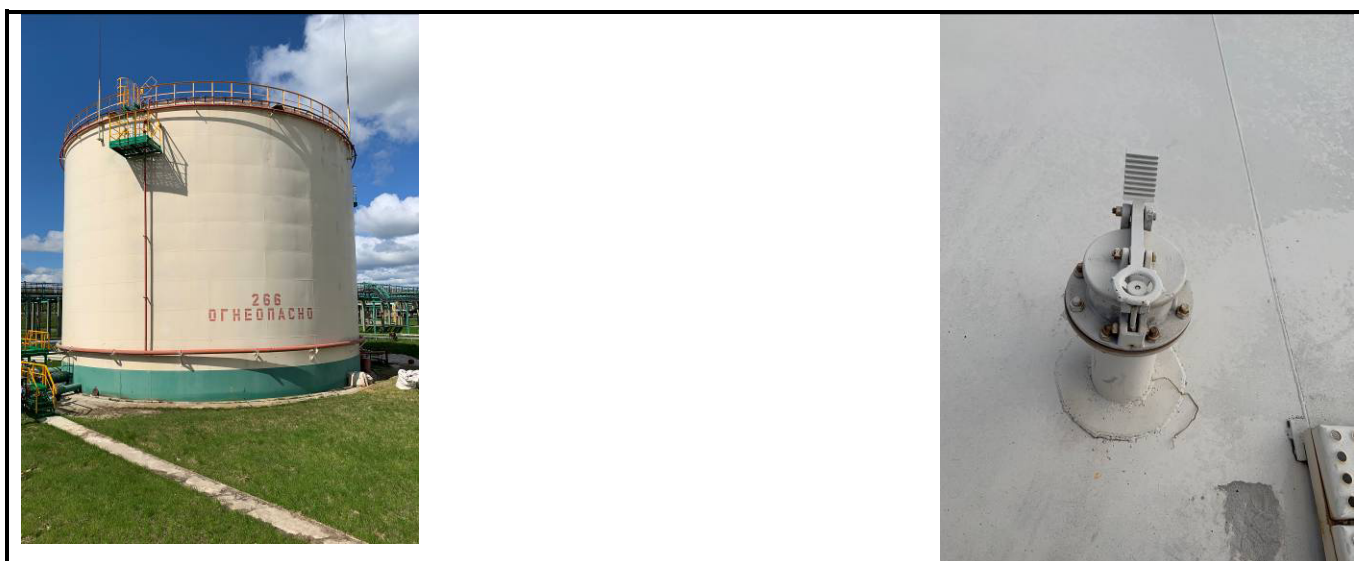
Общий вид резервуара РВСП-5000 (№266) с замерным люком
